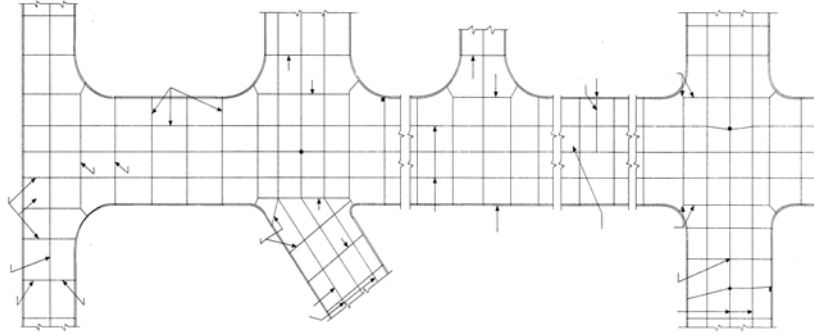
Distribución de juntas en pavimentos simples
